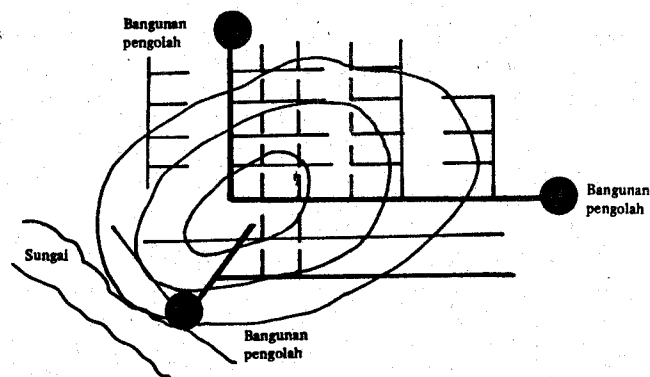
Denah pengelolaan air limbah dengan pola penahan.
